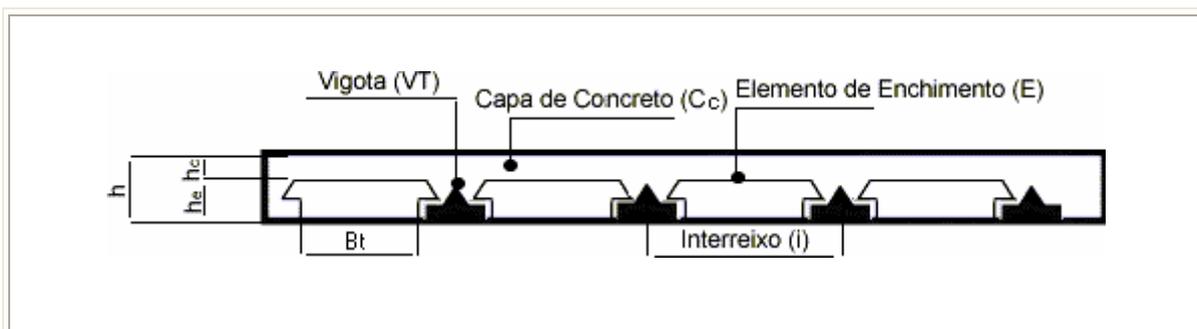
Laje com vigotas treliçadas (VT). (Adaptada)
